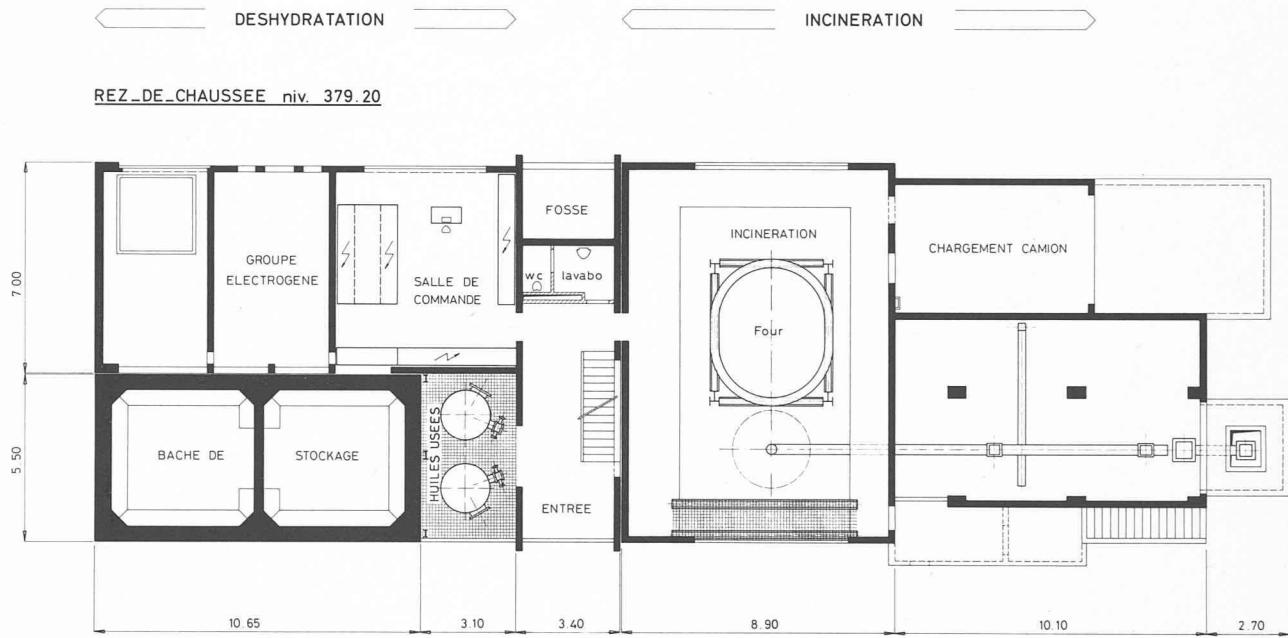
Plan de l'usine, rez-de-chaussée.
